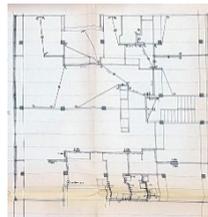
Planta Instalaciones B-2-3. 1964. Fuente: Archivo Municipal da Coruña
